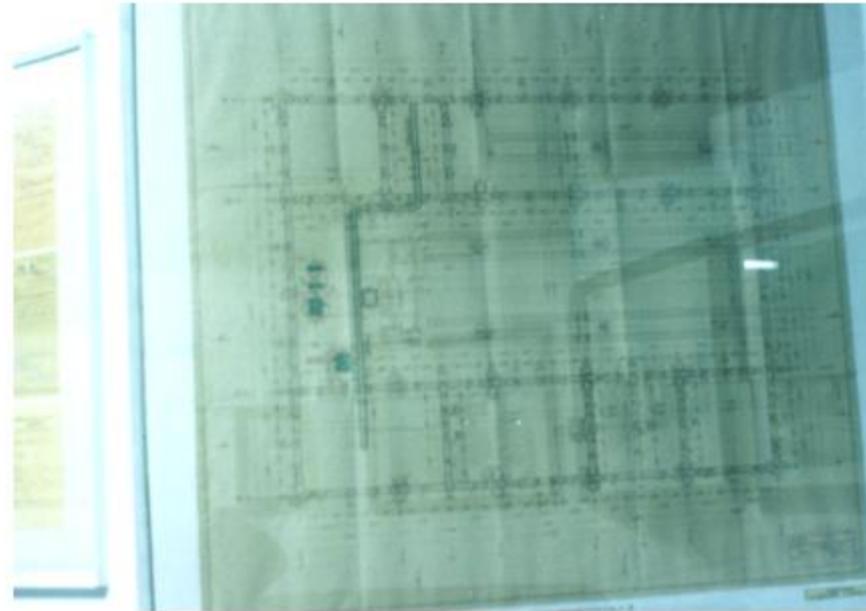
Plano de la planta acotada de la nave central del Ferrocarril. Fuente: Museo del Ferrocarril de los Altos.
